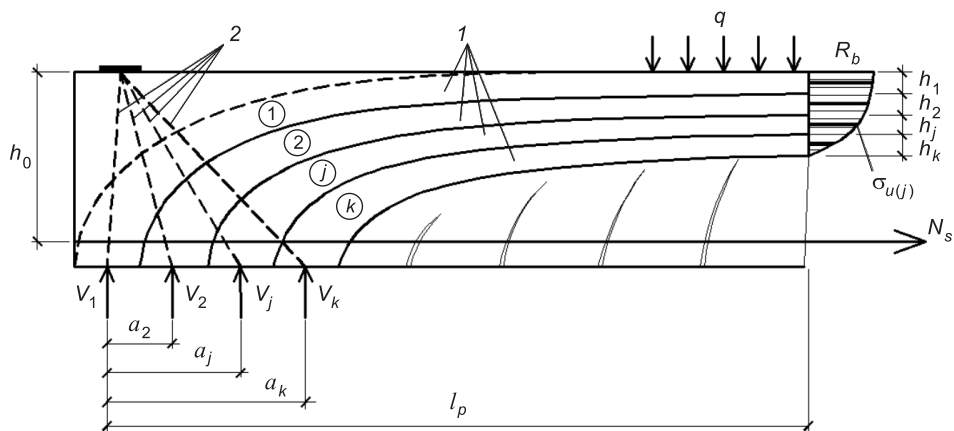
Расчетная многослойная арочная модель железобетонной балки
